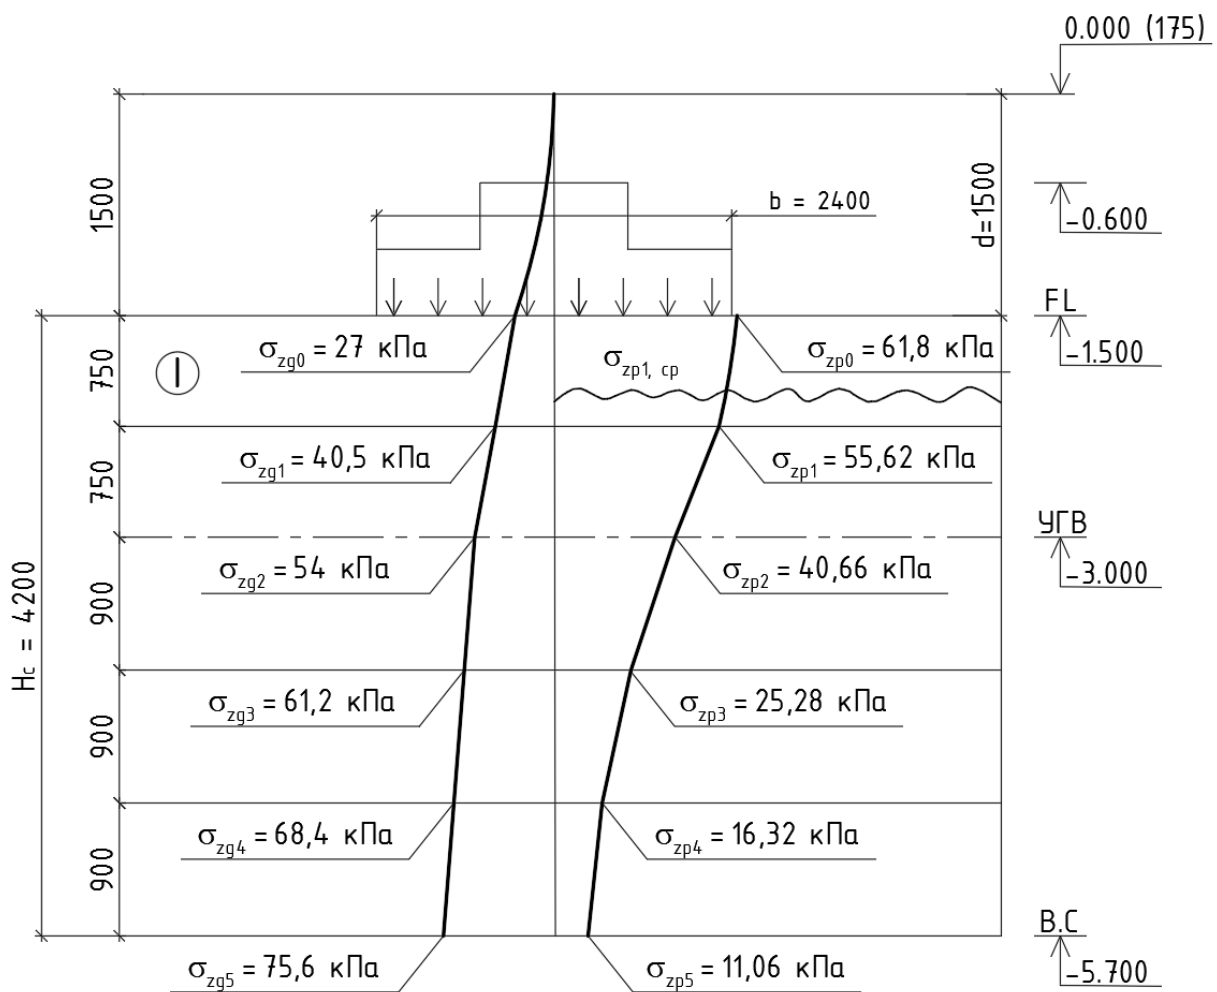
Схема для расчета абсолютной осадки фундамента
